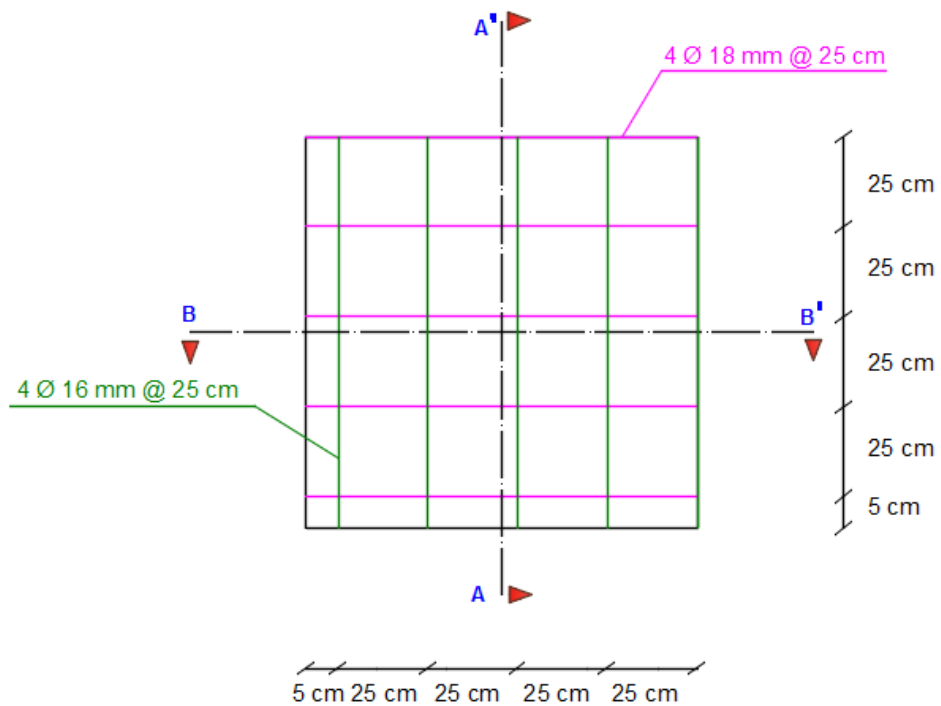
ARMADURA INFERIOR DEL TABLERO.
